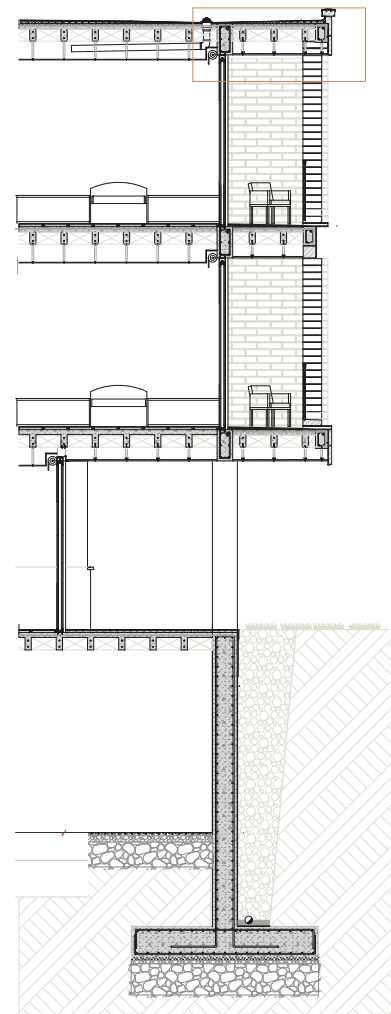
Sección constructiva. Fuente: Autoría propia.
